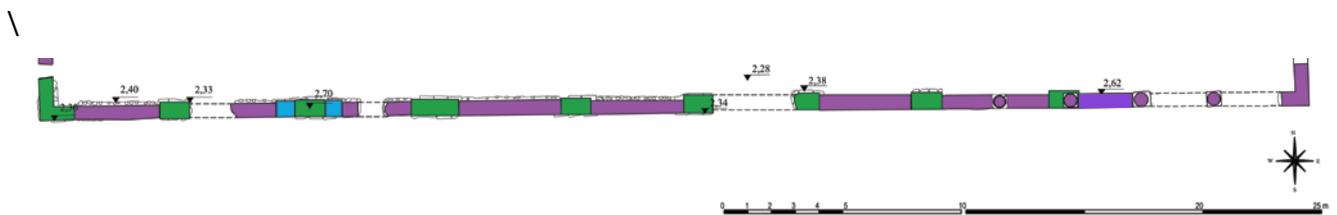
Pianta schematica del portico lungo il decumano. In verde i pilastri posta a quota m 2,33 slm, in azzurro i restringimenti in opera laterizia ed in viola lo stilobate continuo con il colonnato.
